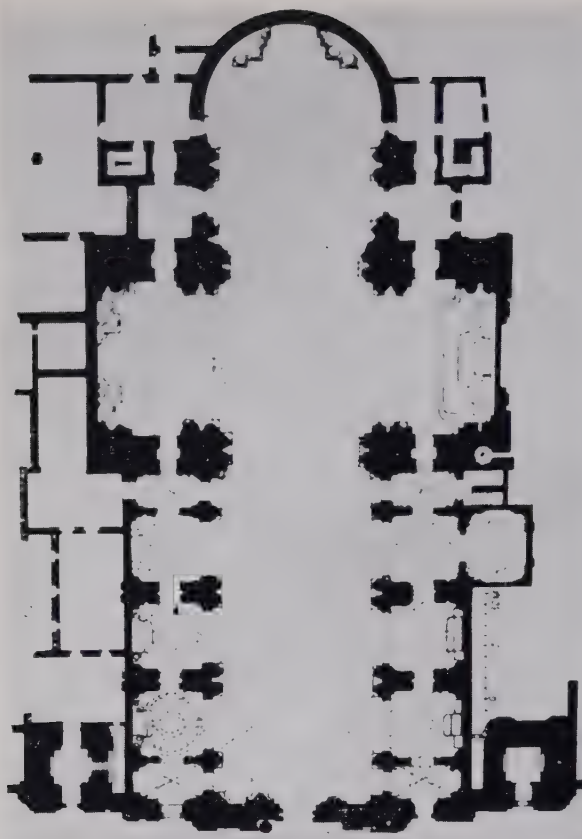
Monaco, Theatinerkirche - Planimetria
